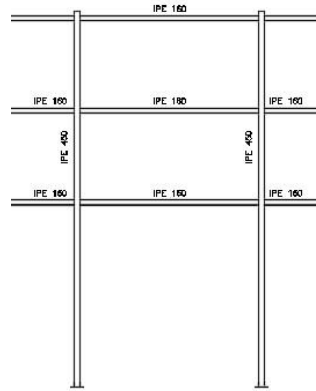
Viga Perimetral. (Fuente: Cype 3D)
